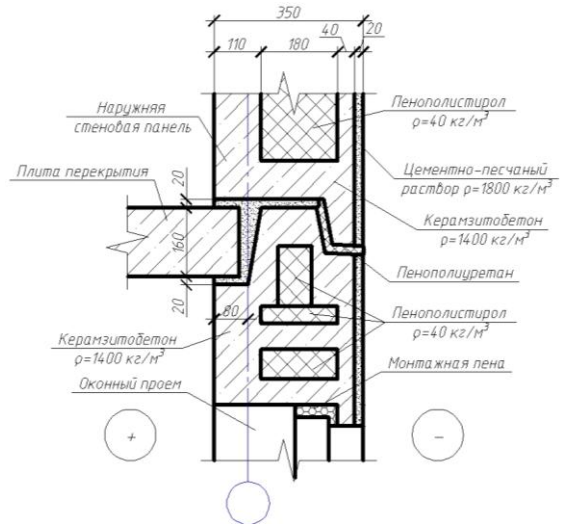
Узел примыкания наружного ограждения к внутренней железобетонной стене и плите перекрытия. Существующее решение
